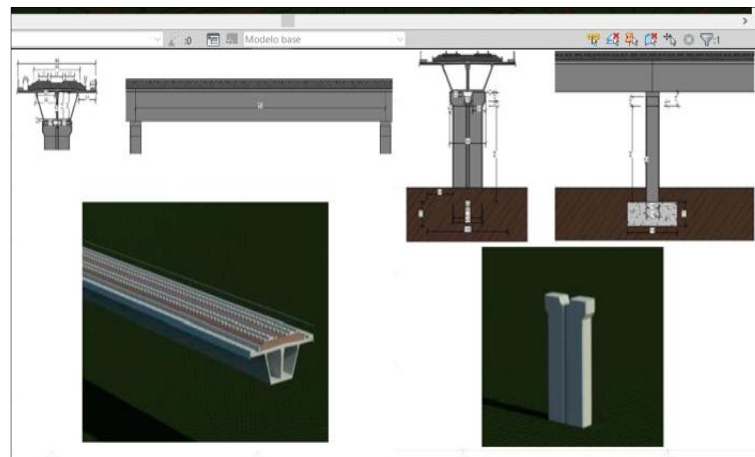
Modelado en Revit (2018) de los elementos estructurales que forman el viaducto. Fuente: Elaboración propia
